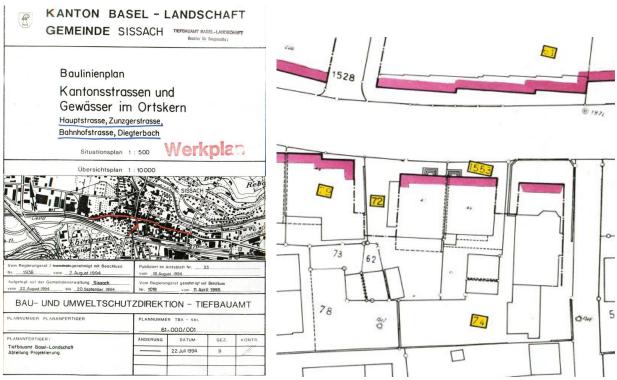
Baulinienplan Kantonsstrassen und Gewässer im Ortskern, Parzelle 72 (Quelle: Ursprungsplan)
